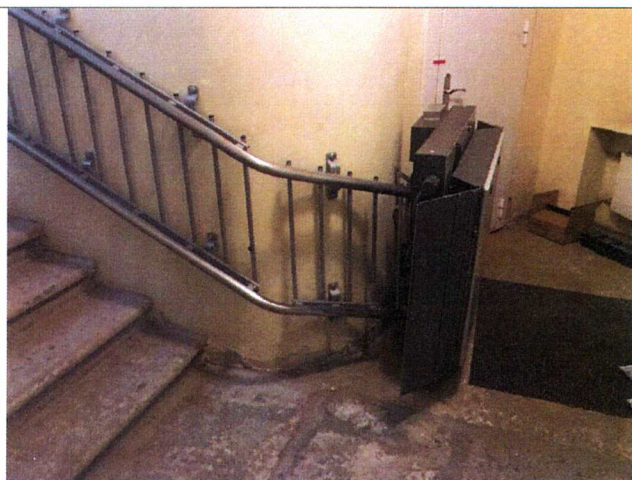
Подъемные платформы с наклонным перемещением до уровня второго этажа
